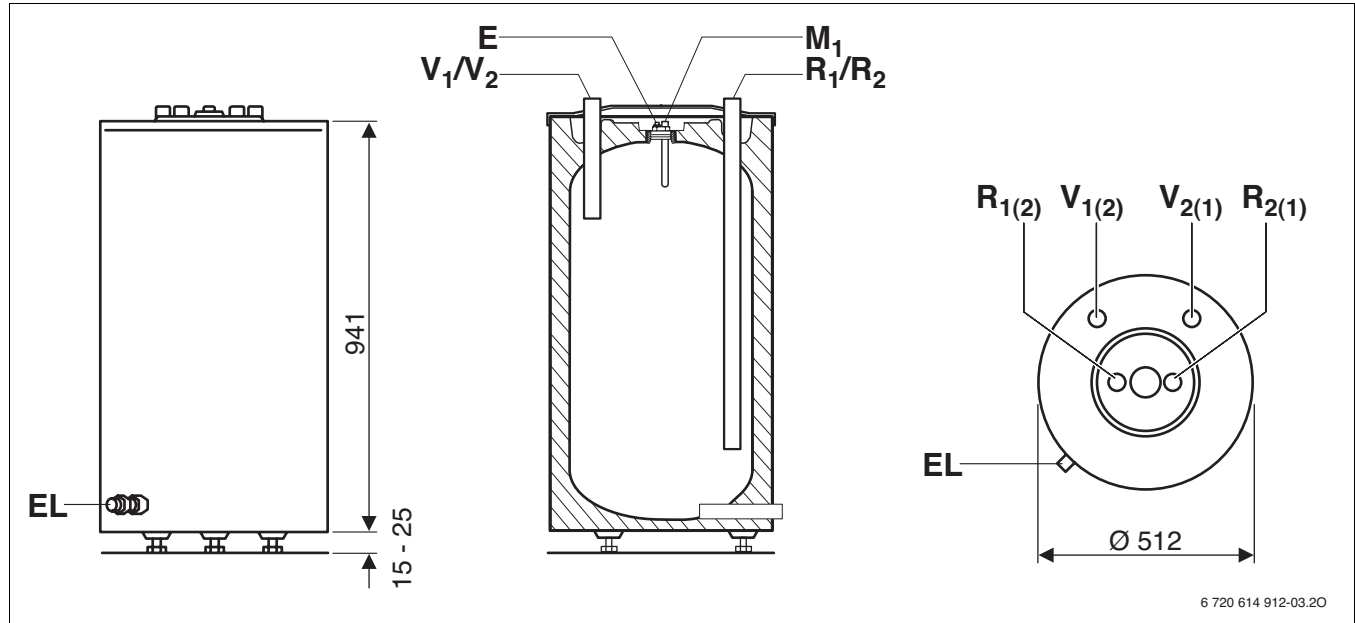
Bau- und Anschlussmaße Pufferspeicher PSW 120 (Maße in mm)
